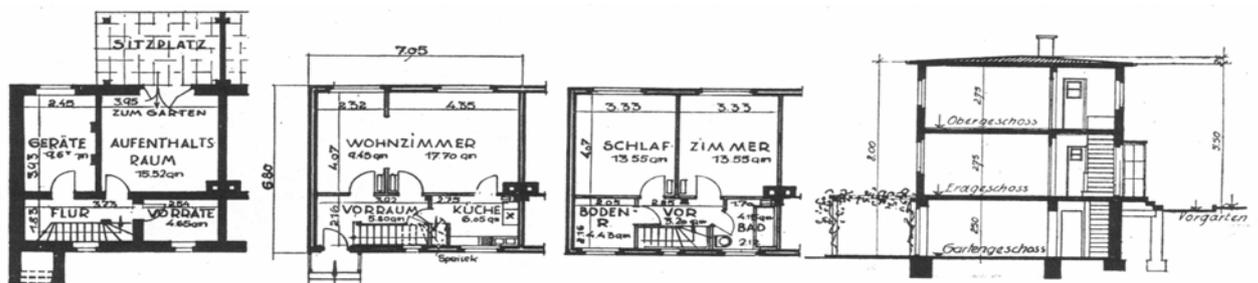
Architekt Hans Waloschek , Grundrisse und Schnitt der Siedlerhäuser,
